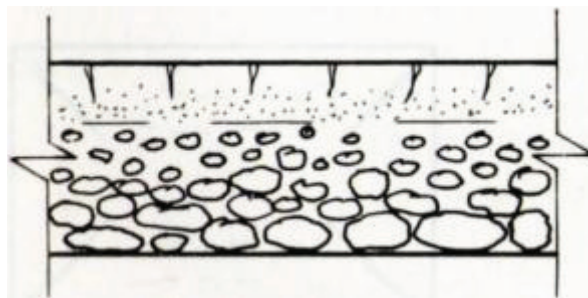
Fissuração por efeito de segregação. Fonte: CÁNOVAS (1988).
